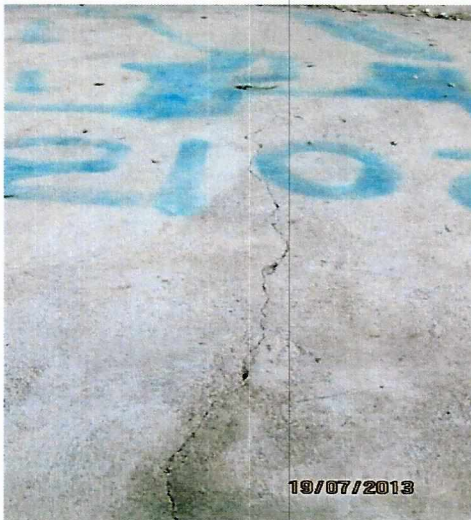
Detalle de una de las fisuras en la superficie de una rampa.
